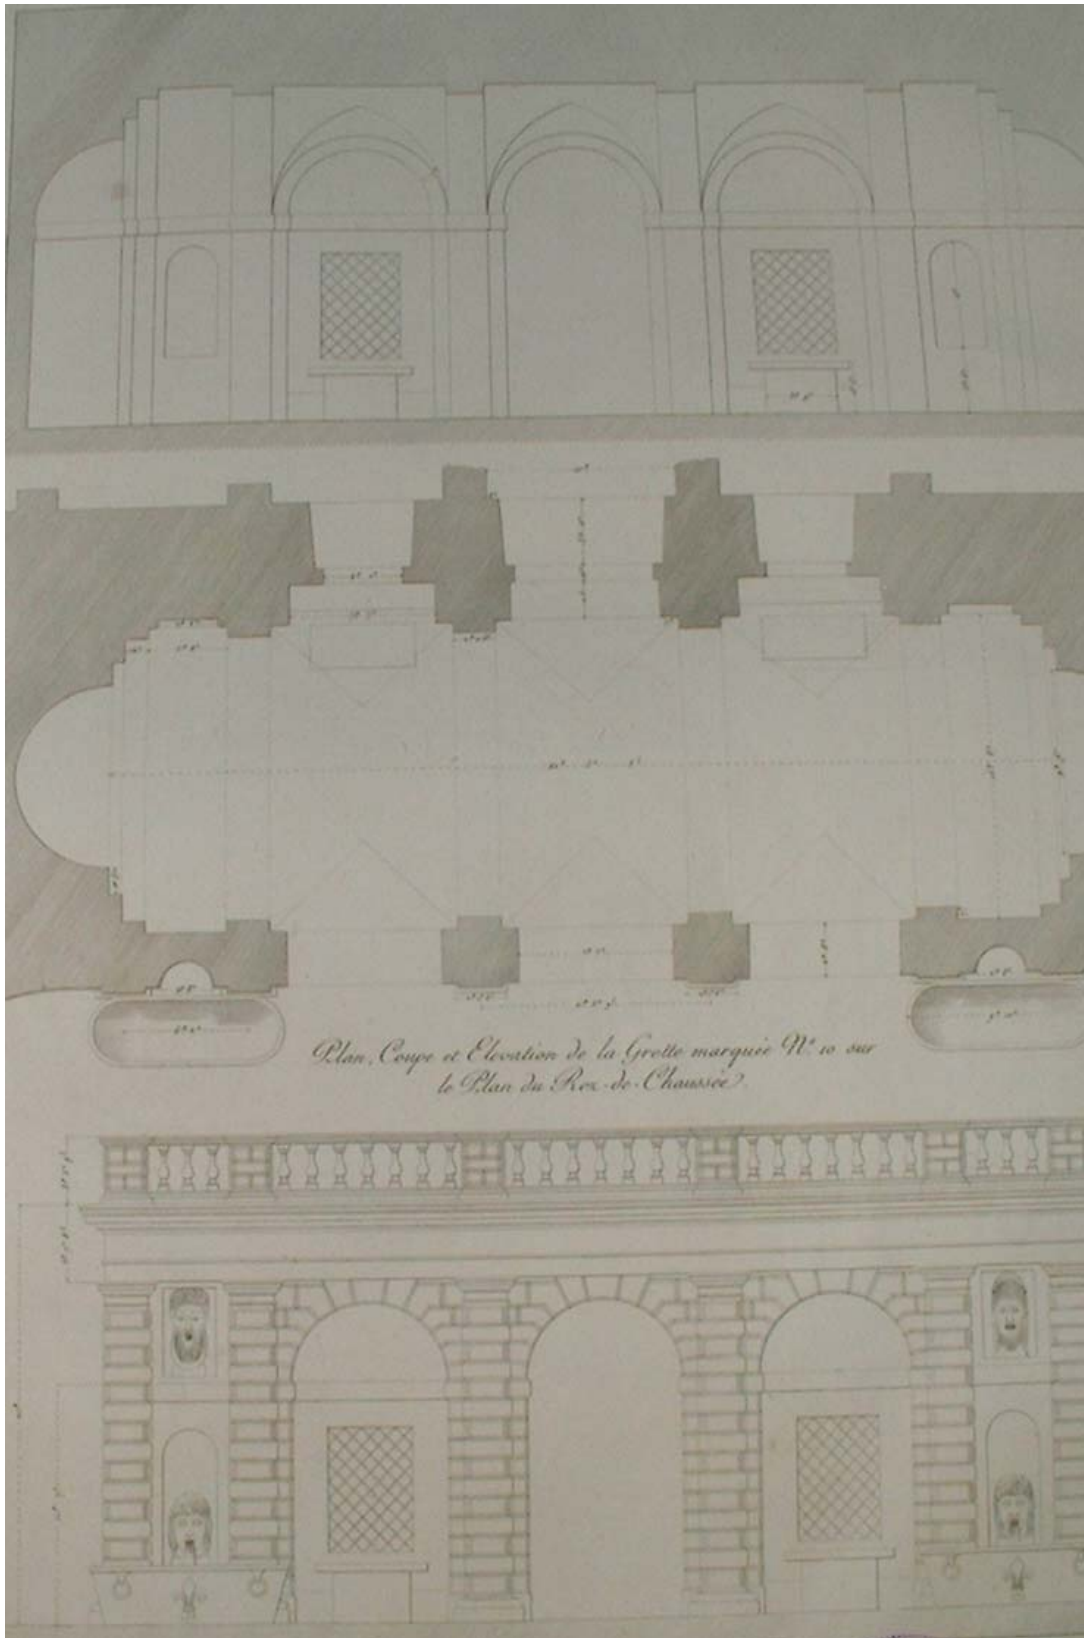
, plan, coupe, élévation de la grotte marquée N°10 sur le plan du rez de chaussée, Palais Caprarola à Rome, Mariette, 18,5 x 24 cm.
